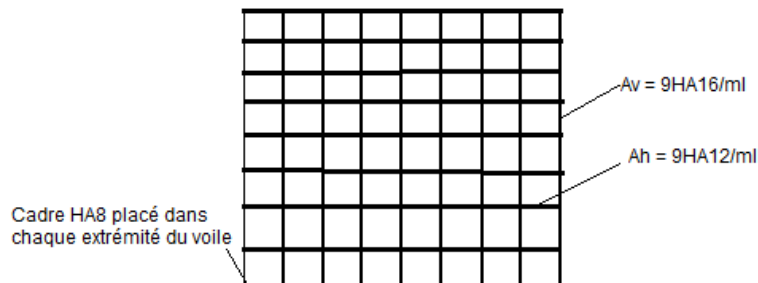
Coupe verticale du schéma du ferrailage des voiles.
